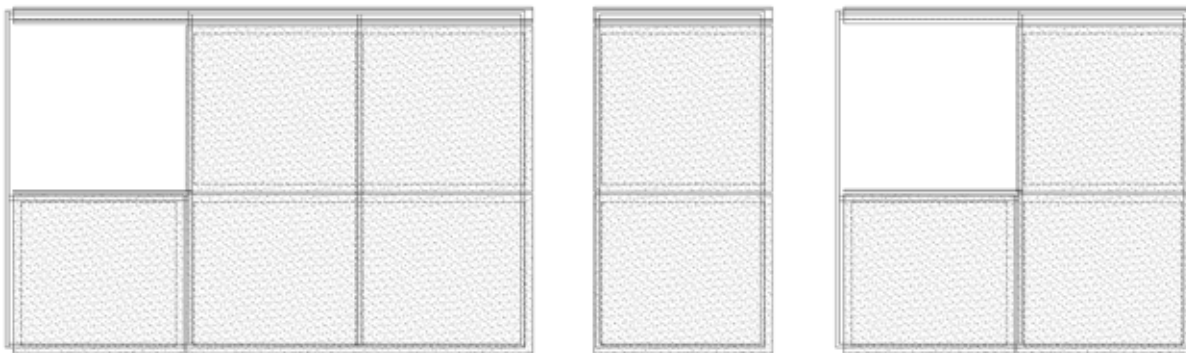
Fassadenelement Typen. Zeichnung: a..t..f architektur technik fassade GbR
